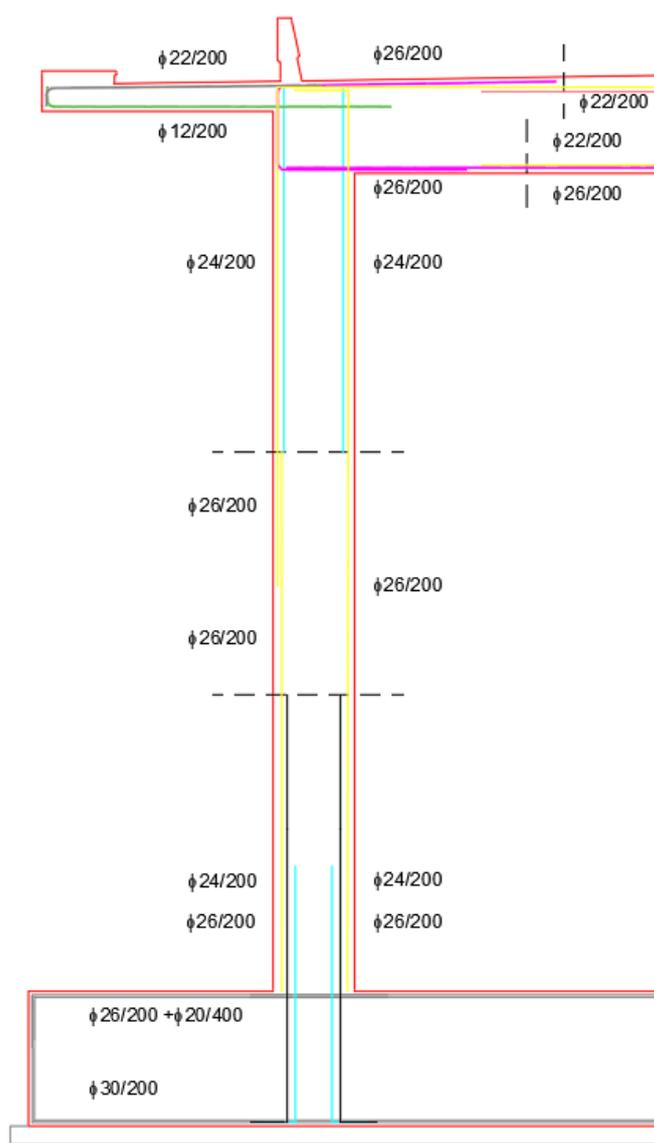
Schema indicativo armature sezione corrente scatolare
